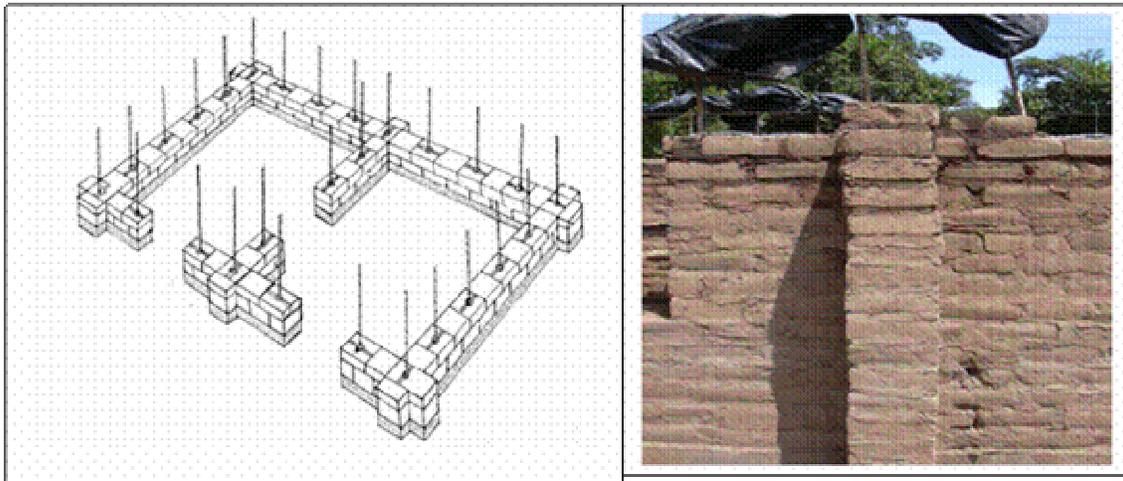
Edificación de adobe con Contrafuertes y Pilastras (Equipo Maiz, 2001, Dowling, 2002).
